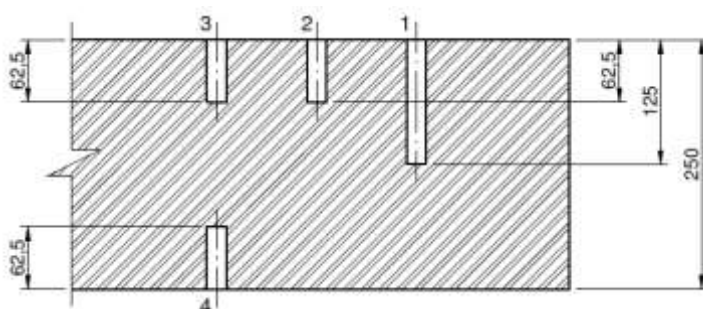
Profundidade dos pontos medição e posicionamento dos termopares ao longo da espessura da placa. Dimensões em mm.
